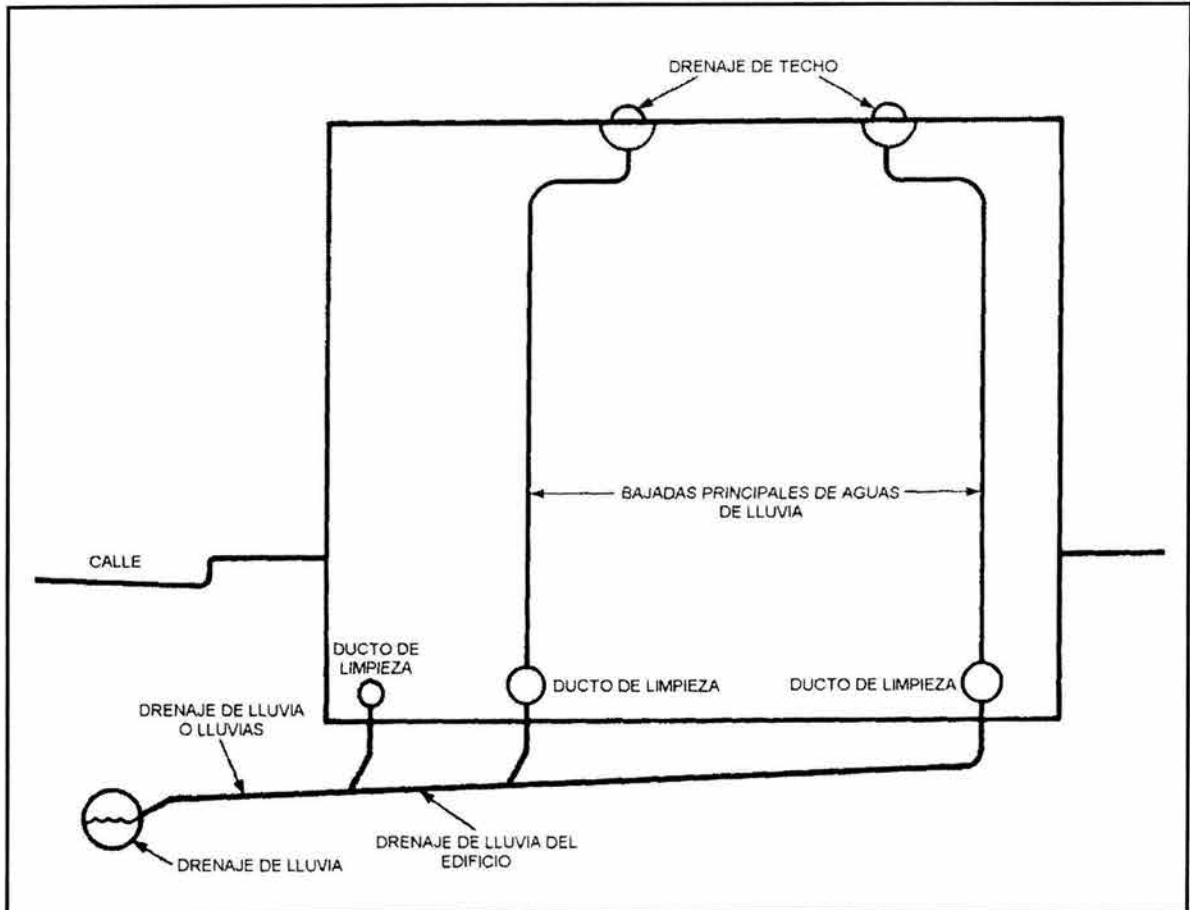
Sistema de drenaje de aguas pluviales de una edificación.
